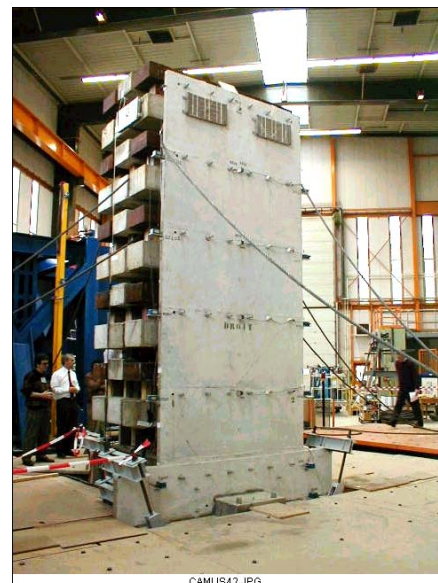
Photo B : un essai de structure à mur en béton sur la table sismique Azalée du CEA Saclay
